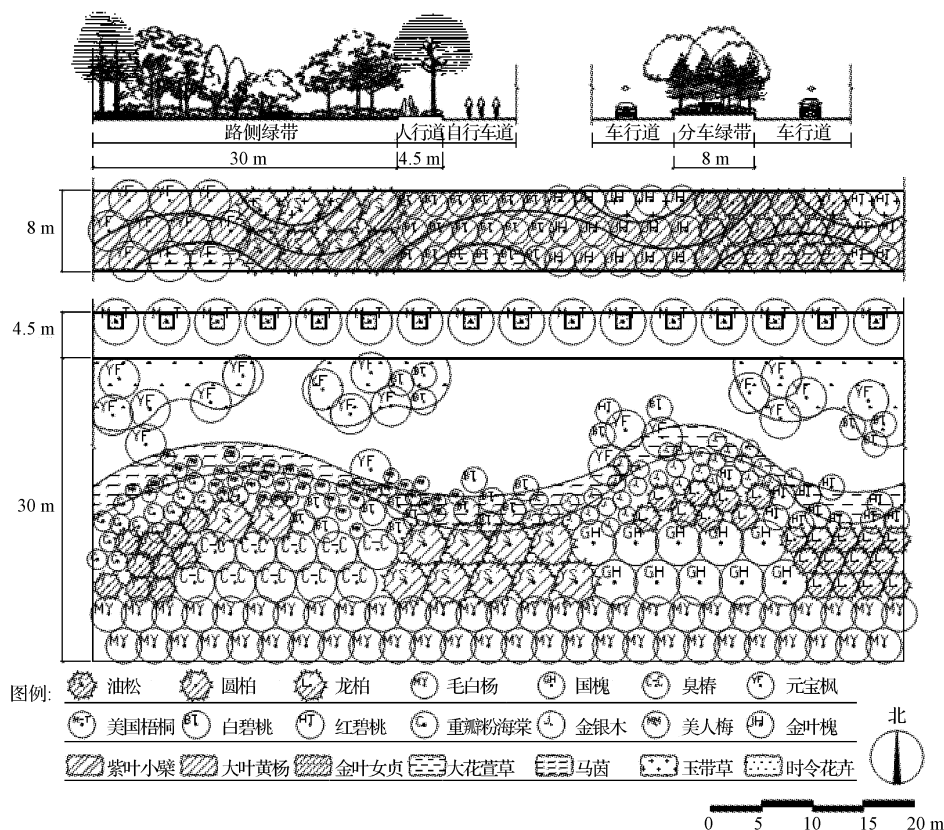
30 m宽路侧绿带及8 m宽分车绿带植物配置平面断面图
